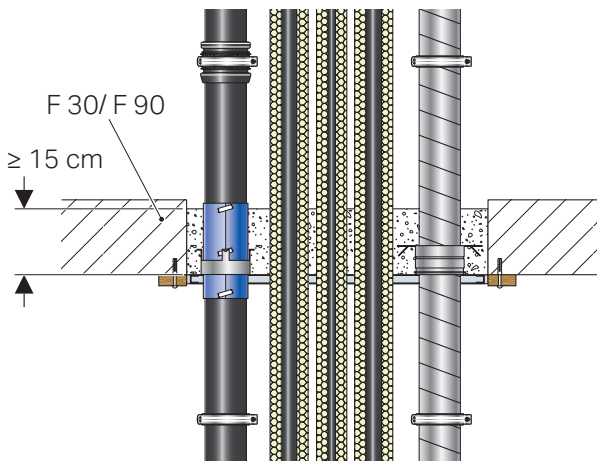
Deckenschott FSH90 unterhalb der Decke montiert
